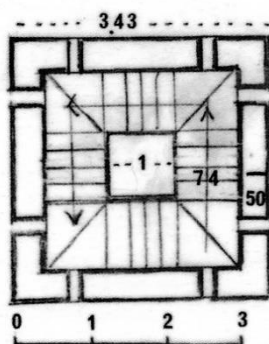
Planta del alminar de Archéz, Málaga. (Pavón Maldonado, 2009).
